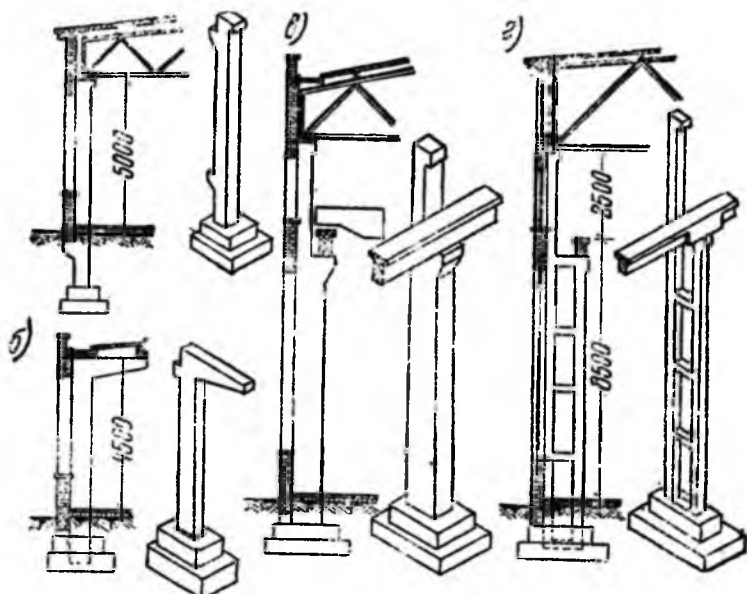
Железобетонные пристенные колонны промышленных зданий
